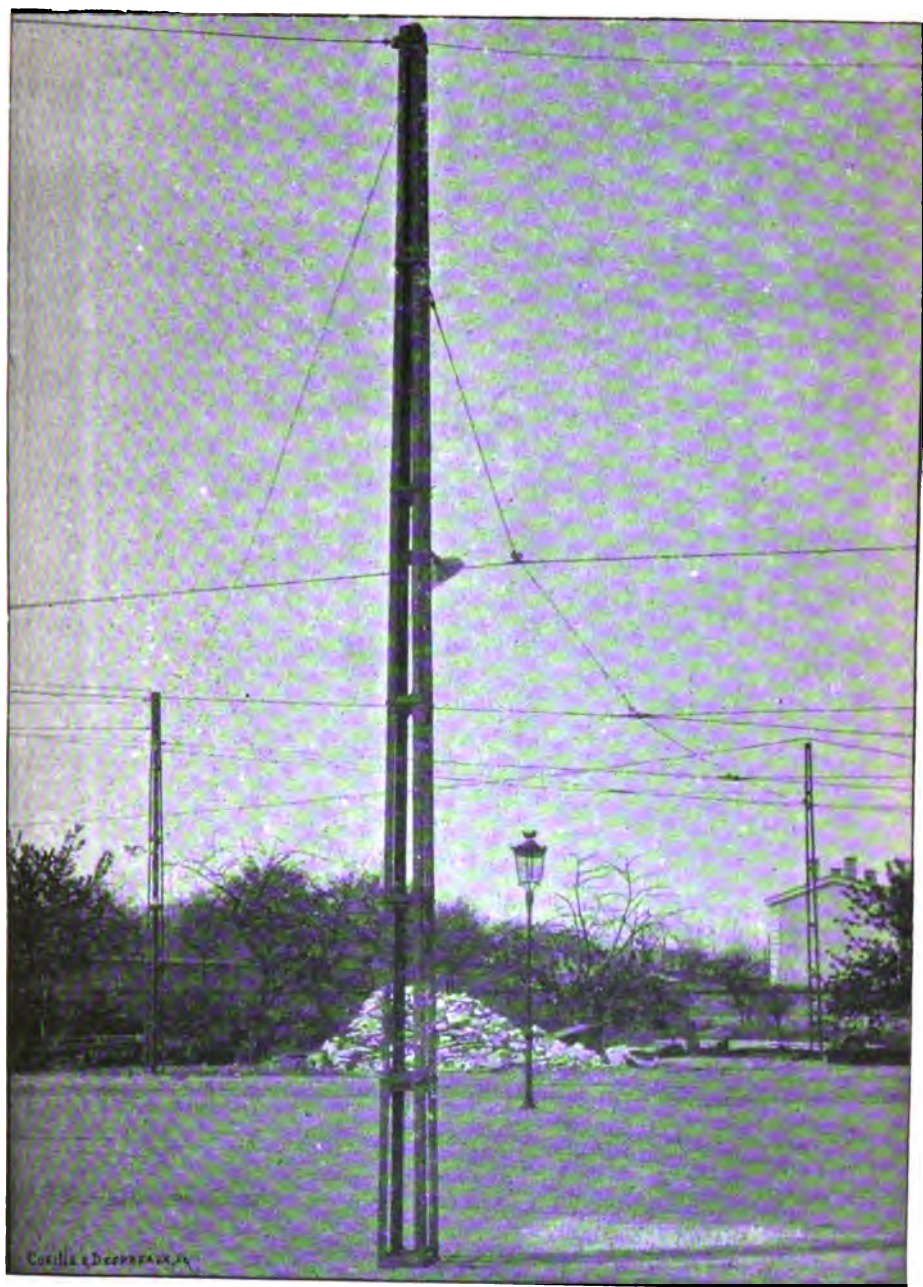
Poteaux, système O. André, installés sur la ligne de Saint-Fons à Lyon (1895).
